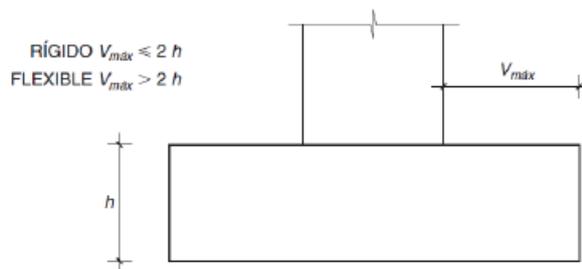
Zapata rígida / flexible. (Fuente: (Miravete & Larrodé, Los transportes en la ingeniería industrial (teoría), 2002))
